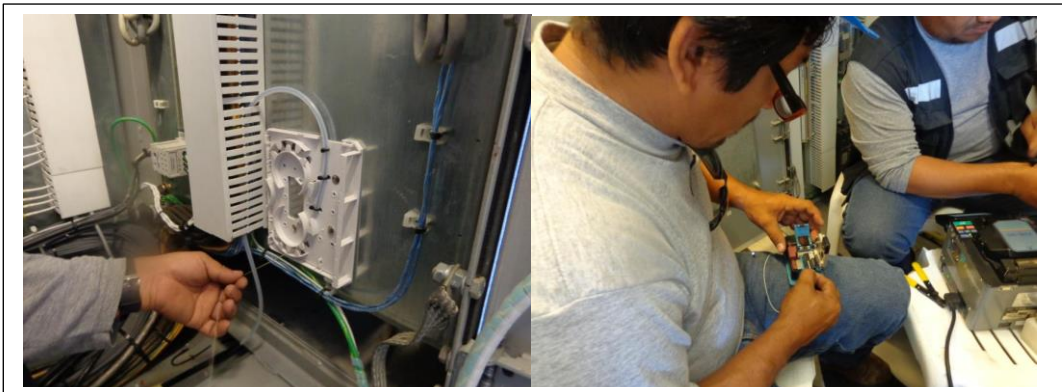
Preparación y peinado de la FO, previo al corte longitudinal
